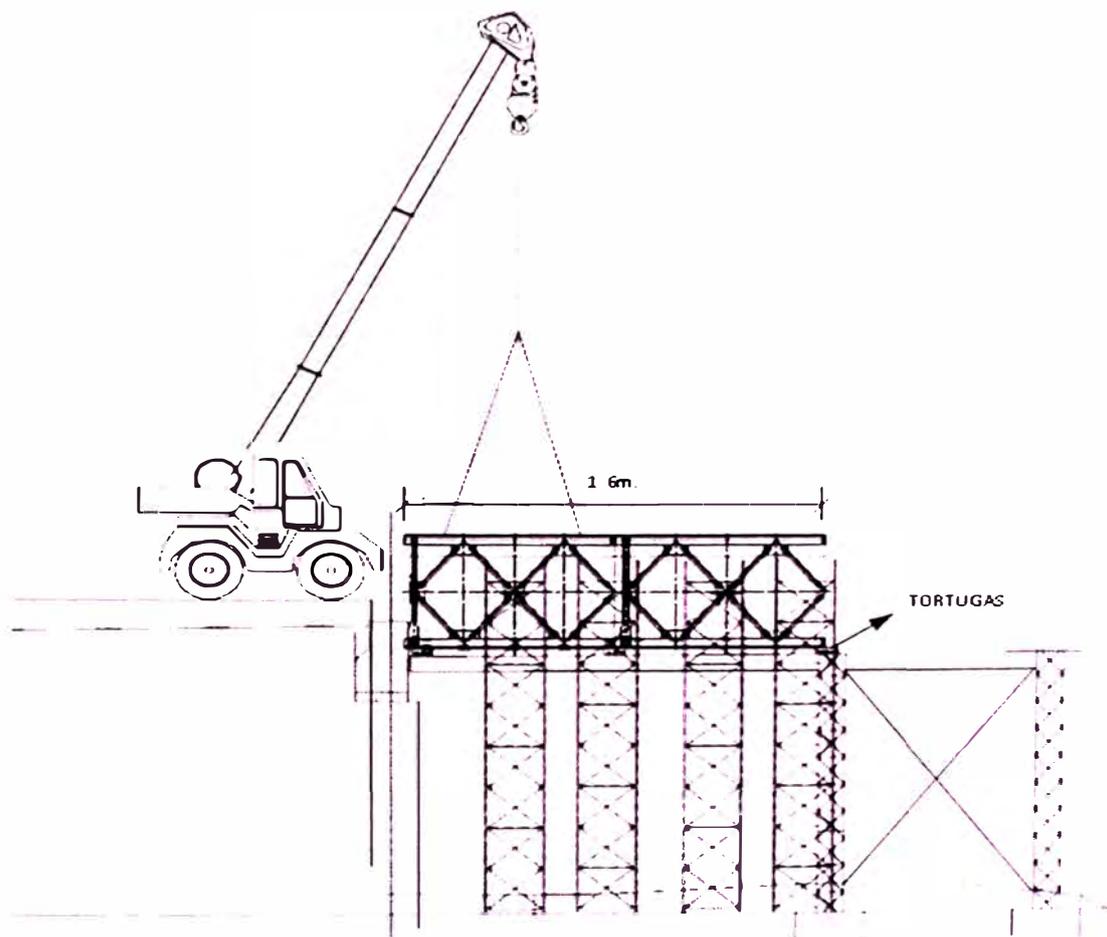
UNIÓN DE MÓDULOS Y DESPLAZAMIENTO HACIA EL PILÓN DEL PUENTE
